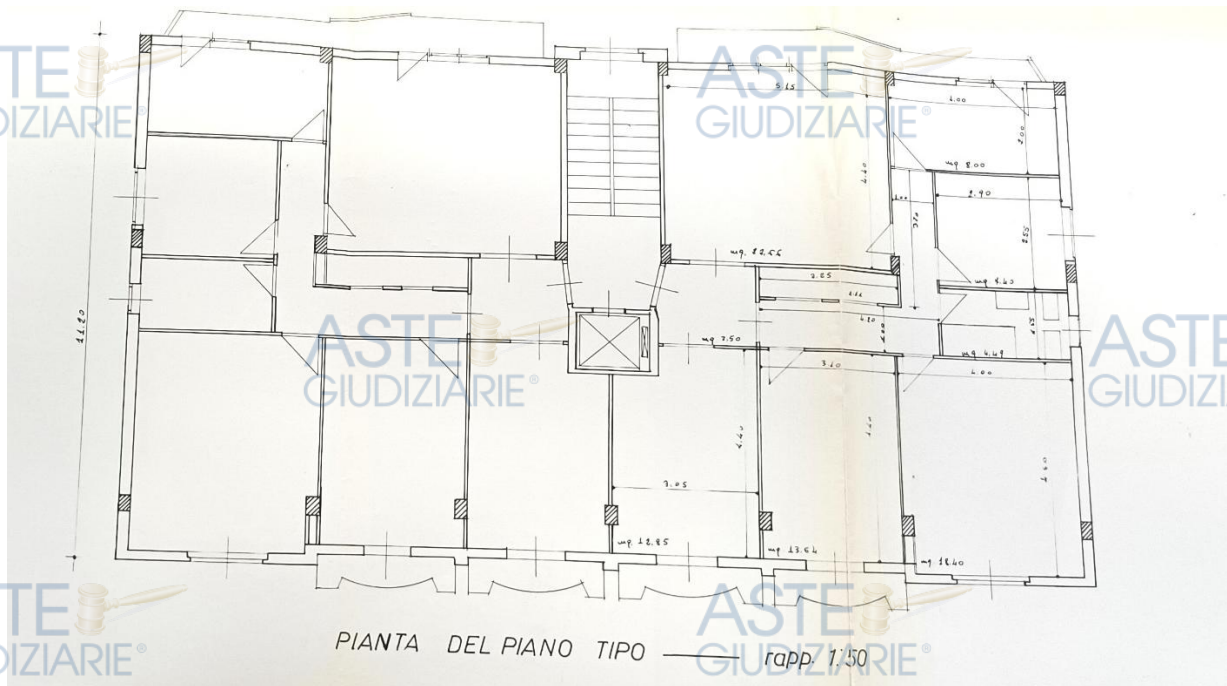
Stralcio delle planimetrie approvate nel 1967- Pianta tipo
